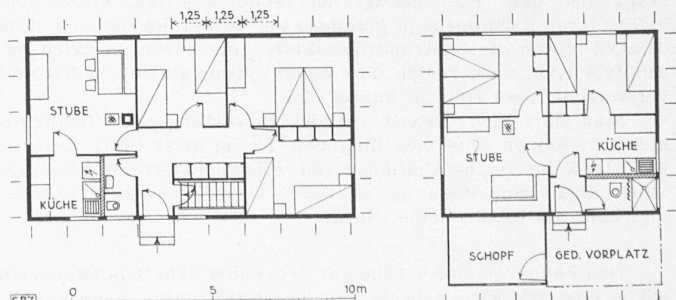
Beispiele der Grundrissgestaltung. Masstab 1 : 250
